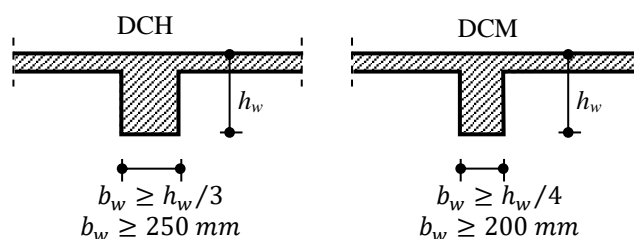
Lățimea minimă a secțiunii transversale a grinzilor
